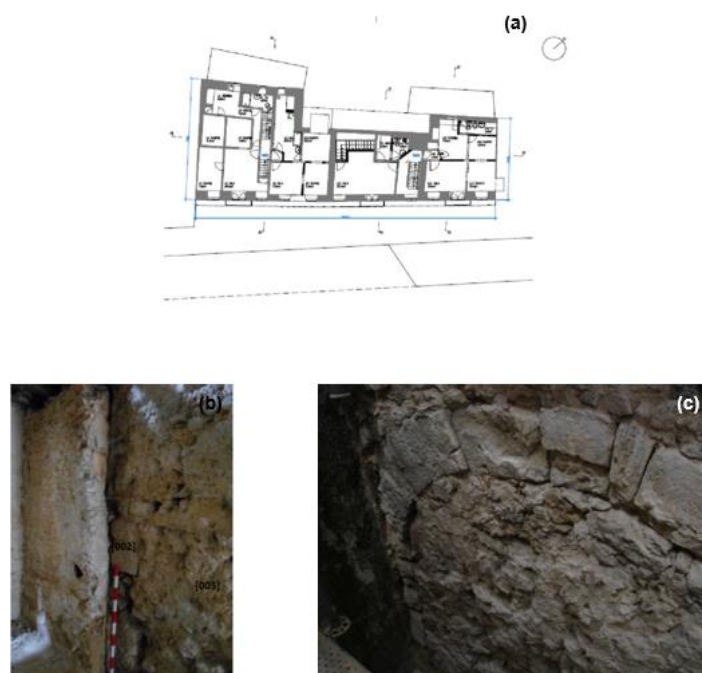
Intervenção na fachada Nordeste de edifício localizado na Rua do Terreiro do Trigo: (a) localização em planta, (b) enchimento da muralha e (c) vão de uma porta da muralha (Krus, 2017)
